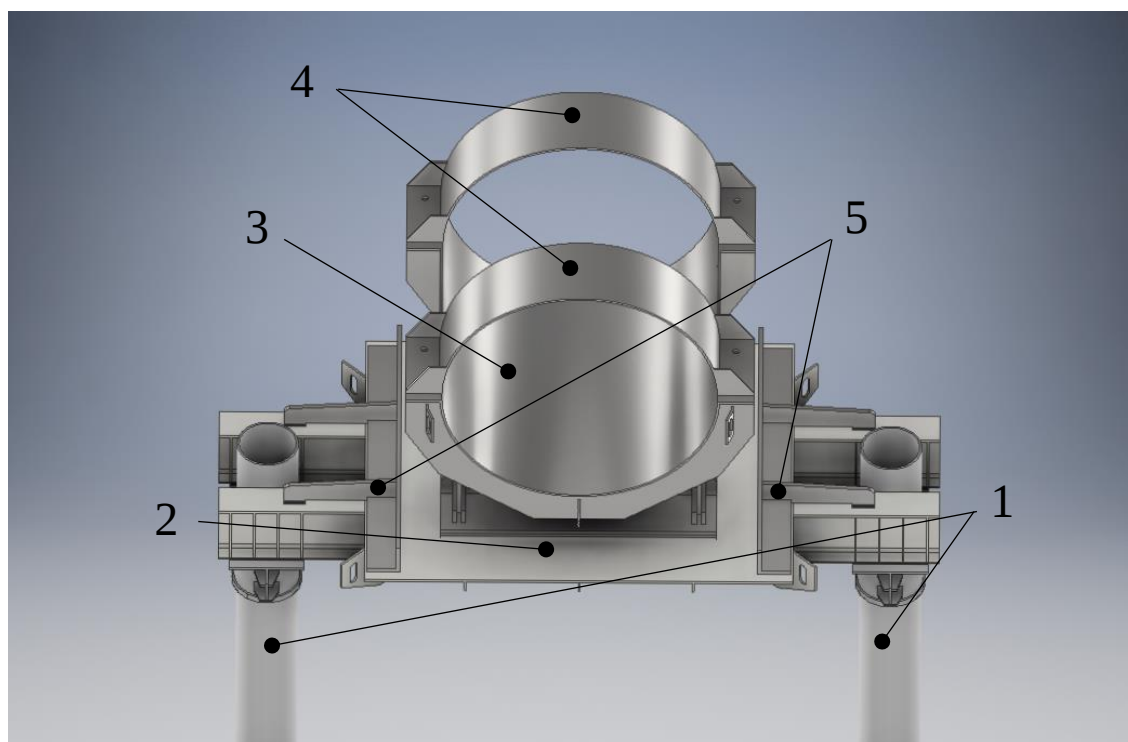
Состав опоры: 1 – сваи; 2 – стол-ростверк; 3 – корпус-ложемент; 4 – полухомуты; 5 – боковые упоры
